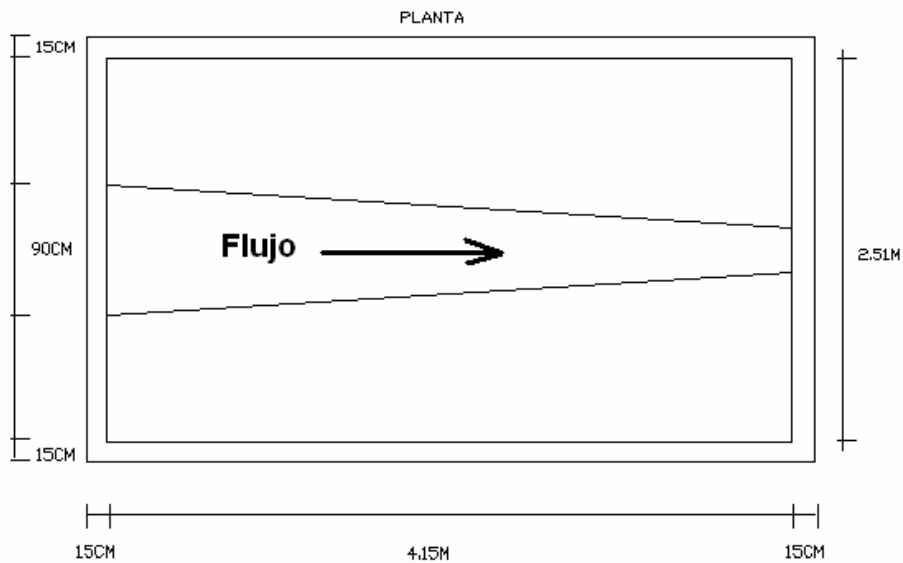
Vista en planta de la caja reguladora.
